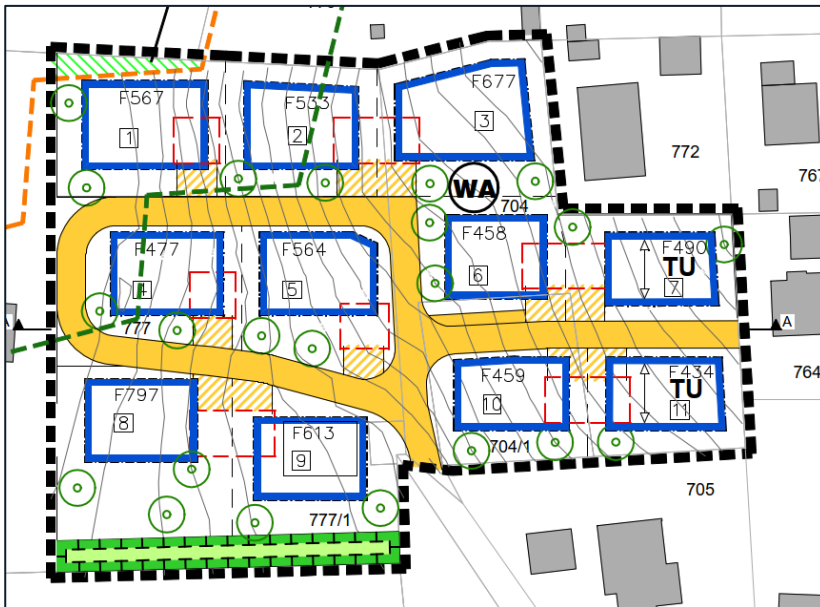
detaillierter Ausschnitt aus dem Bebauungs- und Grünordnungsplan (Bildquelle: Stadt Freyung)
